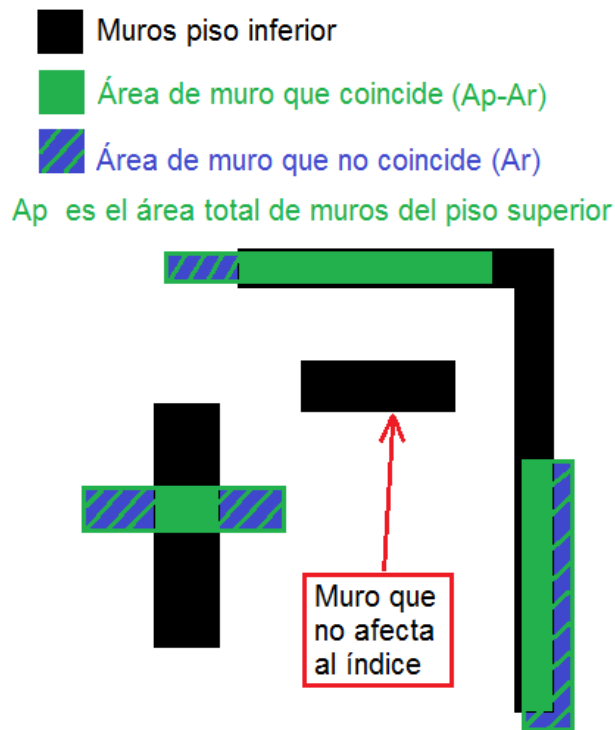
Esquema de discontinuidad de muro en planta (elaboración propia)
